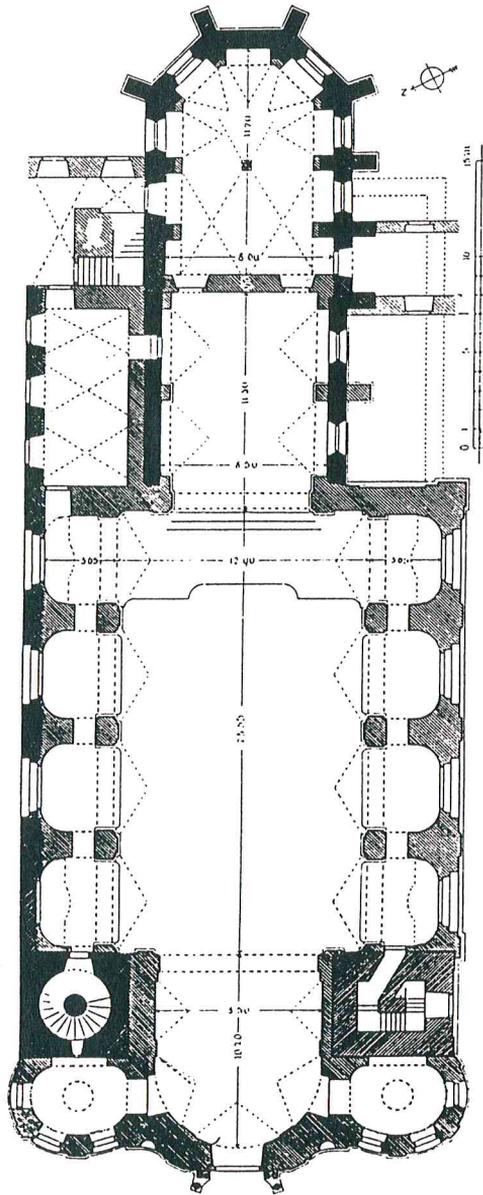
Metten. Grundriss des heutigen Bauzustandes (nach Gröber 1927 [Anm. 53] 144 Fig. 119).
